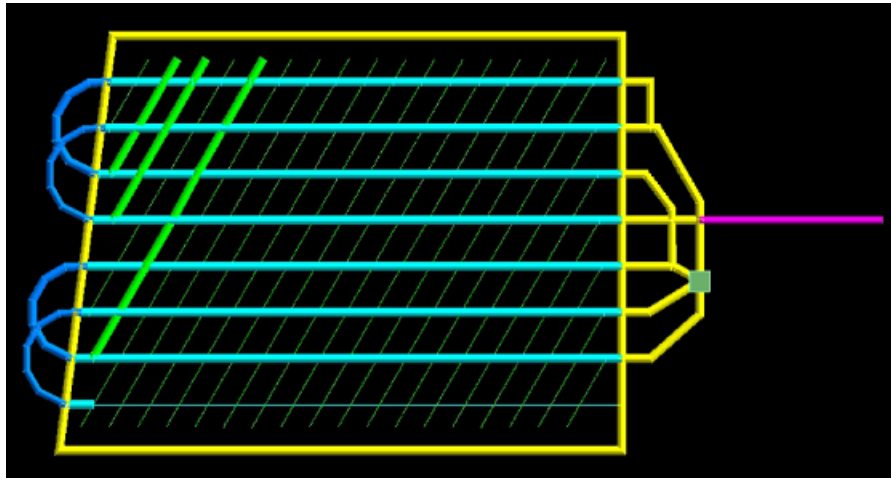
TBM ya construyó la primera calle, realizó el giro y excava una zanja.
